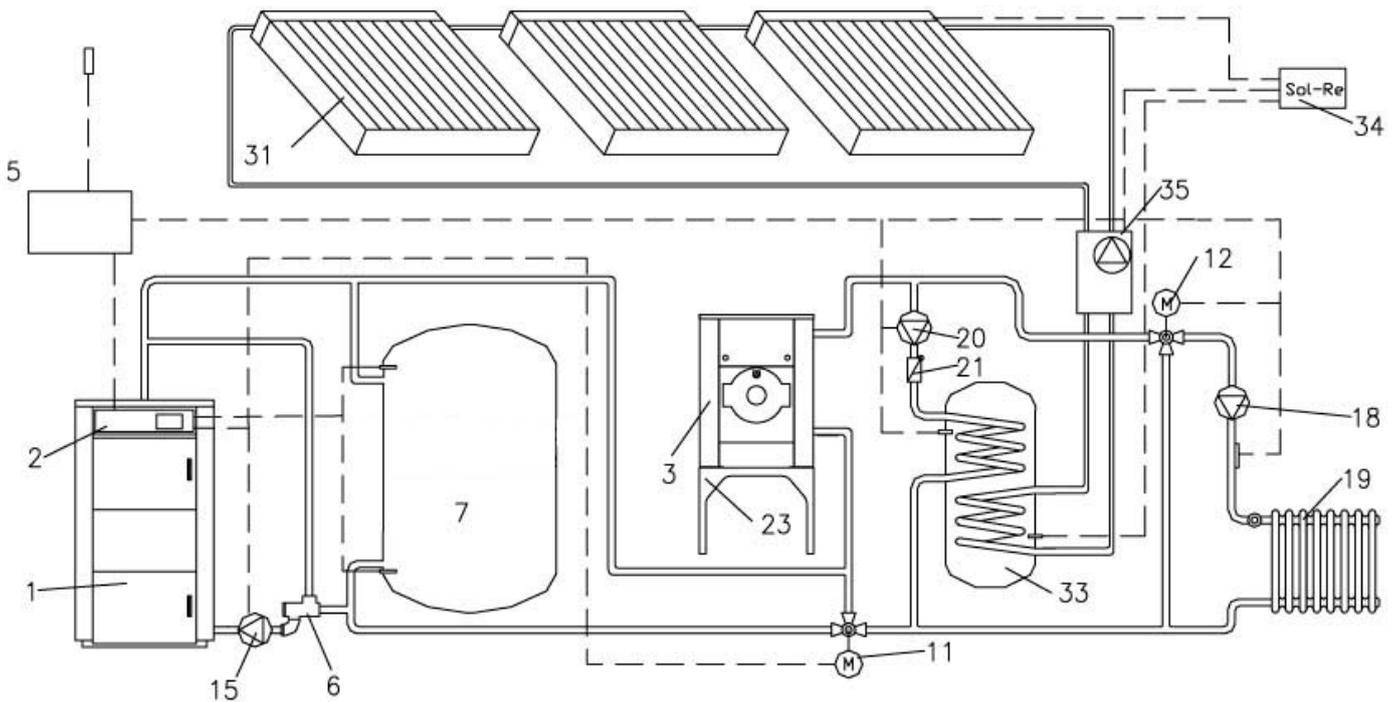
Sonderanlage 8a: Holz-Öl-Heizungsanlage mit nebenstehendem Boiler und solarer Brauchwasserbereitung
